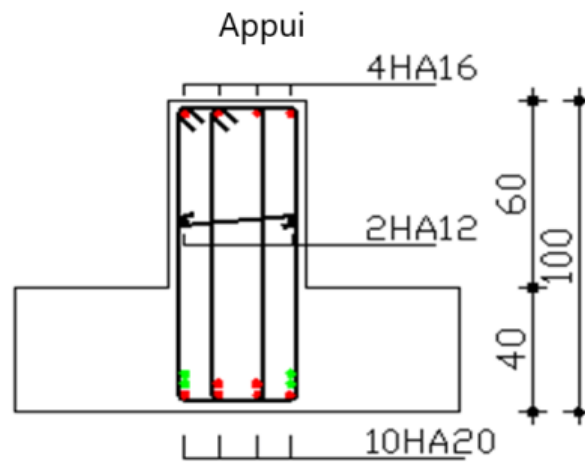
Ferrailage de la poutre principale en appui
